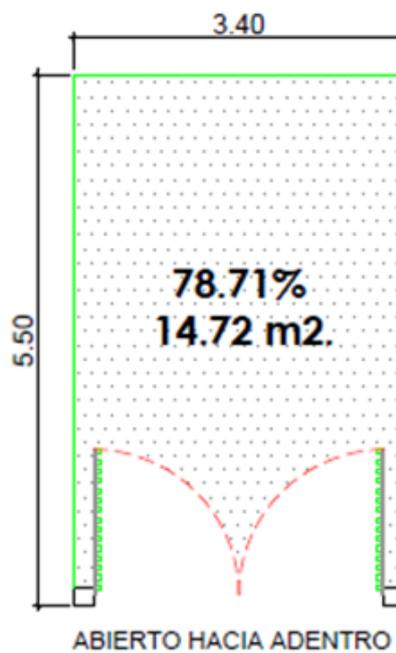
Vista en planta de la superficie del garaje con puerta hacia adentro.
